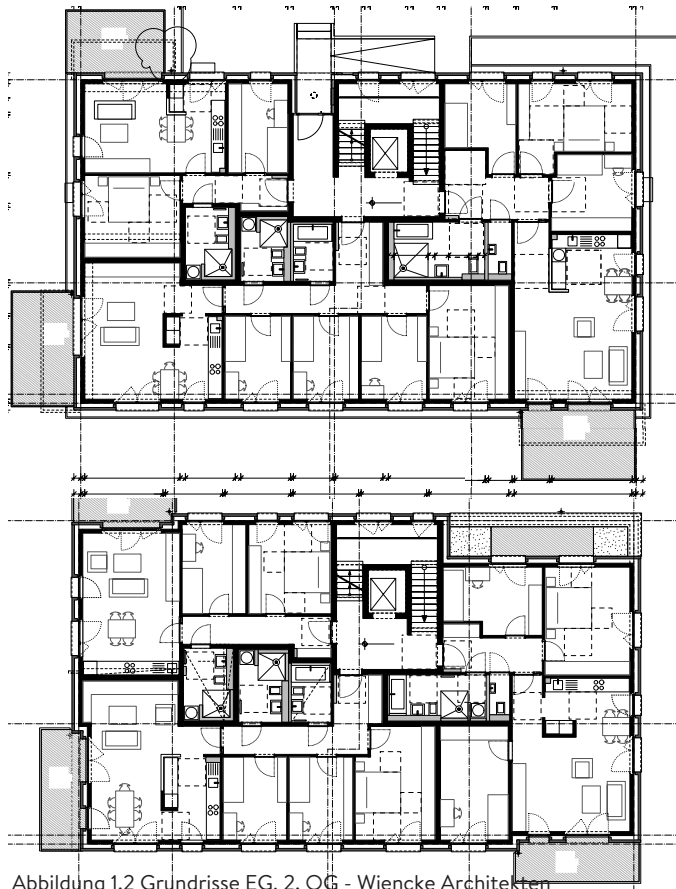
Grundrisse EG, 2. OG - Wiencke Architekten
